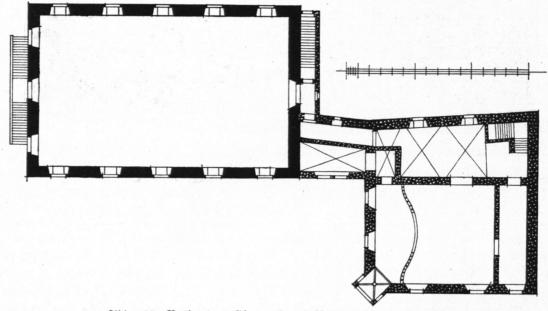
Rathaus ju Cham. Grundriß bes erften Stodwerkes.
